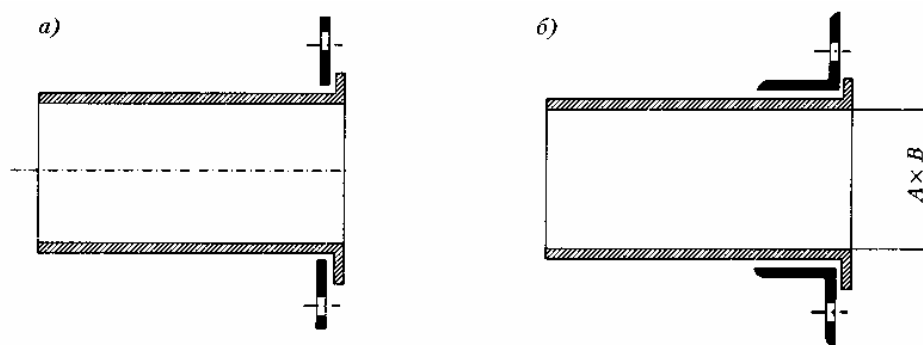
Фланцевое соединение воздухопроводов: *a* и *б* — фланец из листовой стали и уголка
